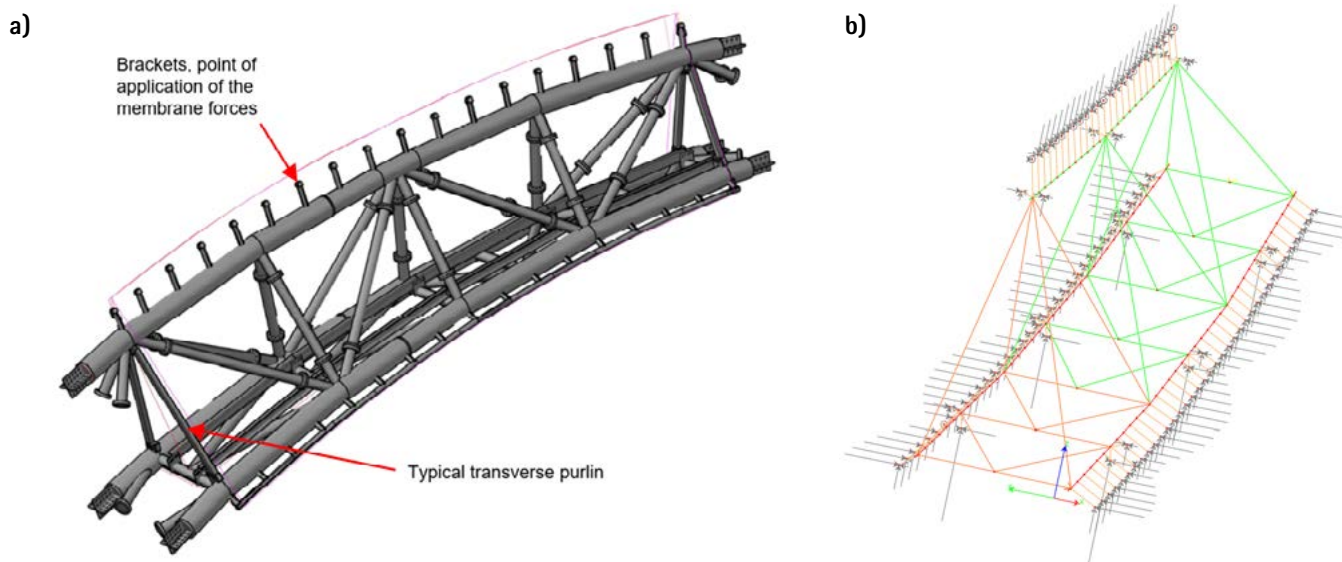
a) Vista 3D di una porzione di struttura reticolare spaziale degli archi; b) Trasferimento alla struttura dei carichi provenienti dalla membrana
